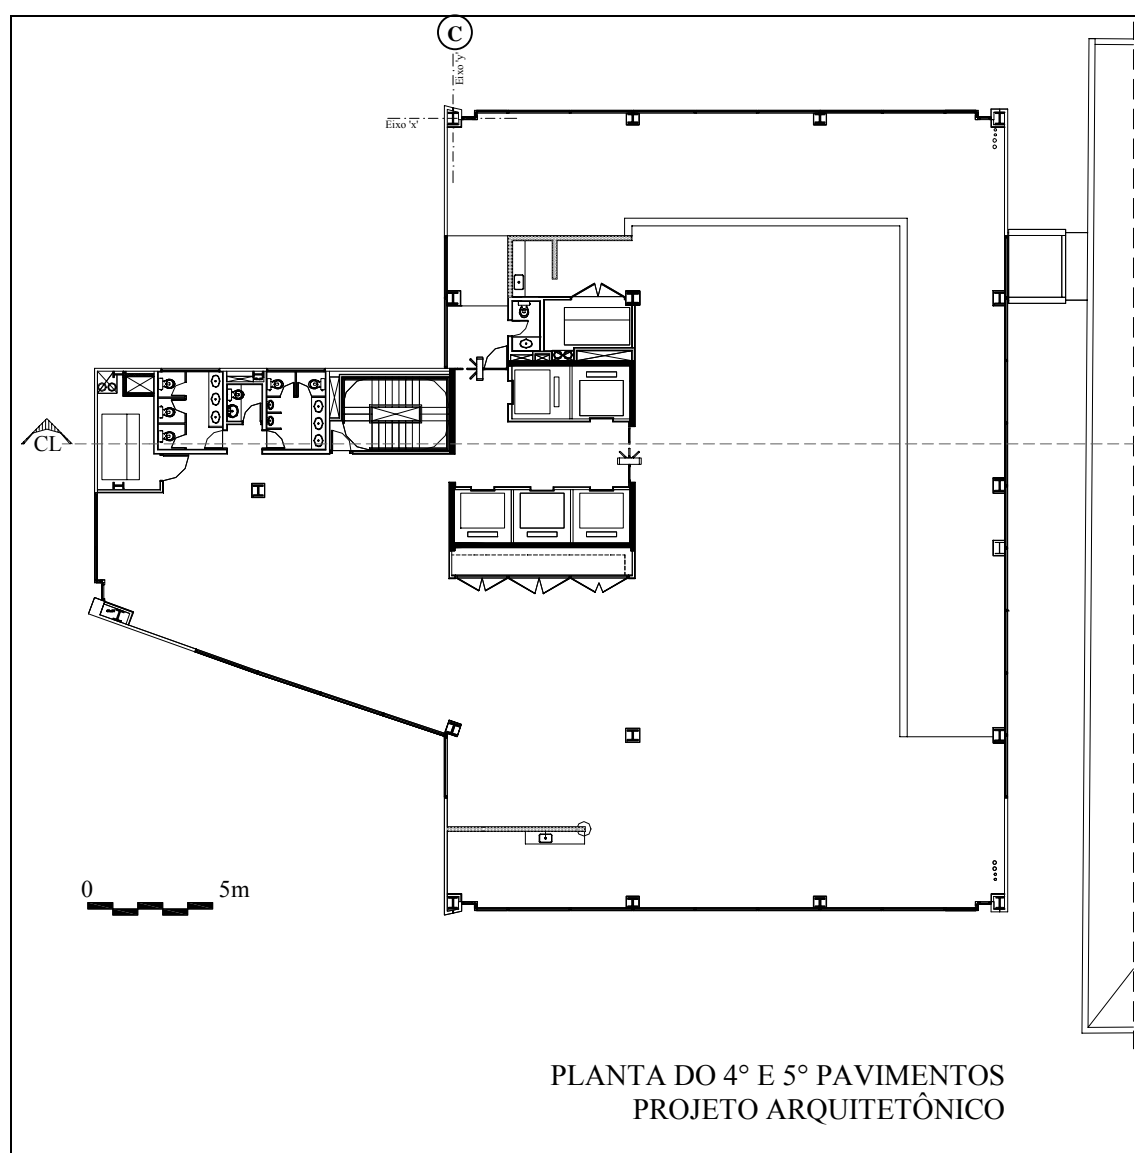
Solução arquitetônica do edifício E-3: esboço da planta dos pavimentos-tipo - *layout* do 4º e do 5º.
